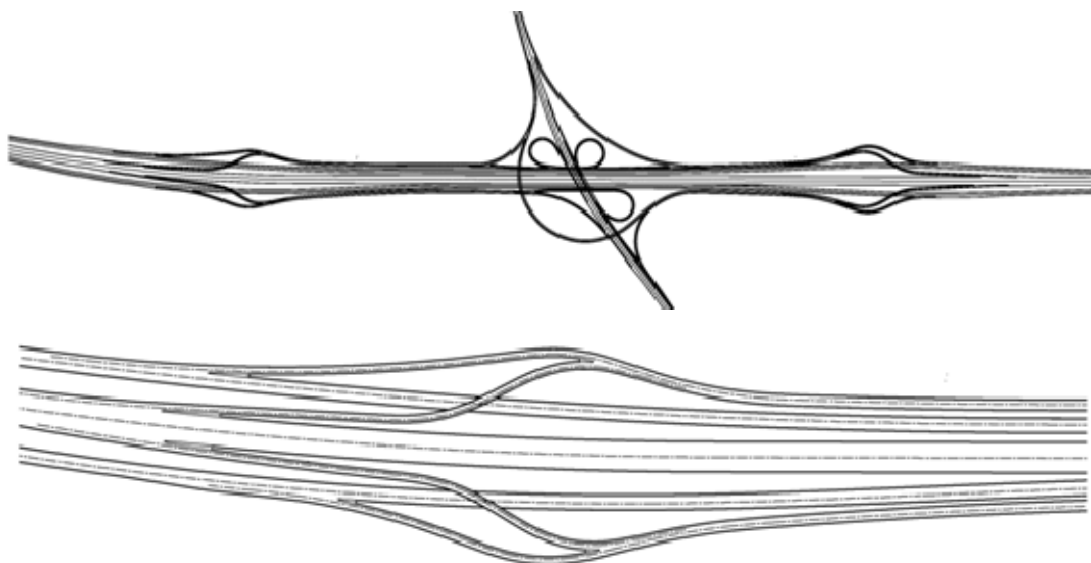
匝道交织复合型枢纽客货分合流典型式平面图及匝道典型形式
